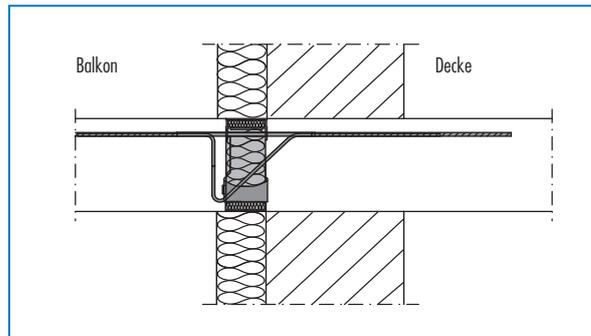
Mauerwerk mit Aussendämmung bei deckengleichem Balkon
